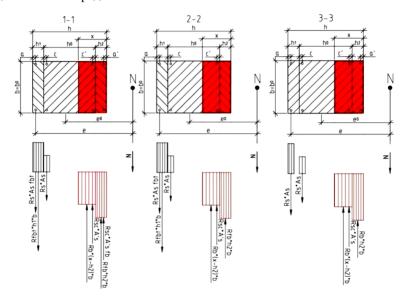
Схемы усиления железобетонной колонны методом двустороннего наращивания при помощи сталефибробетона и железобетона и схемы усилий и эпюры напряжений в сечении, нормальном к продольной оси изгибаемой колонны
